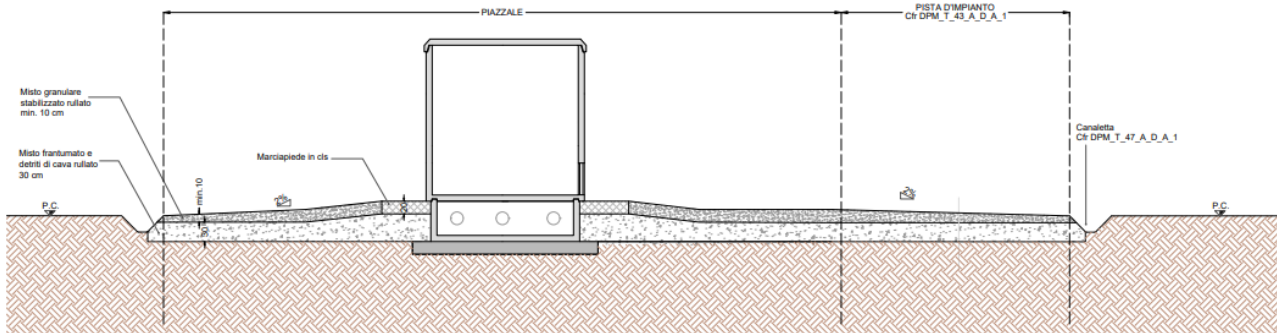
Sezione tipo di piazzale di impianto in piano, misure in cm
